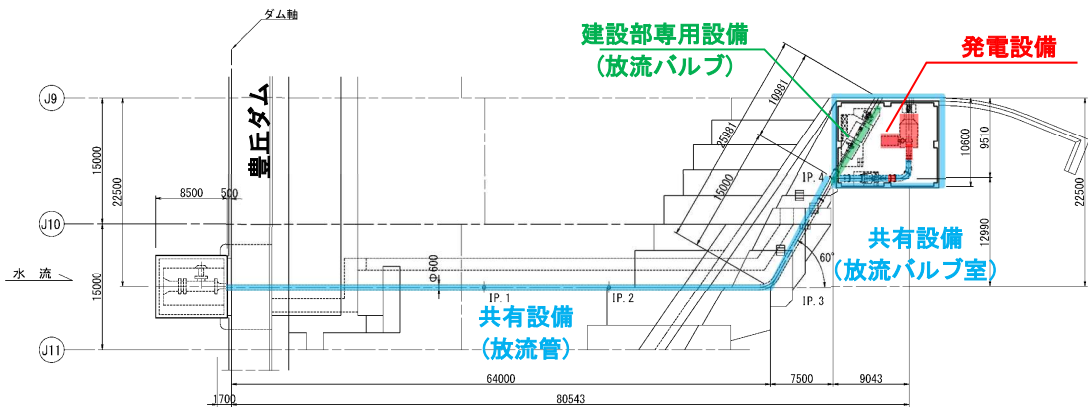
豊丘ダム発電設備他関連設備（平面図）
